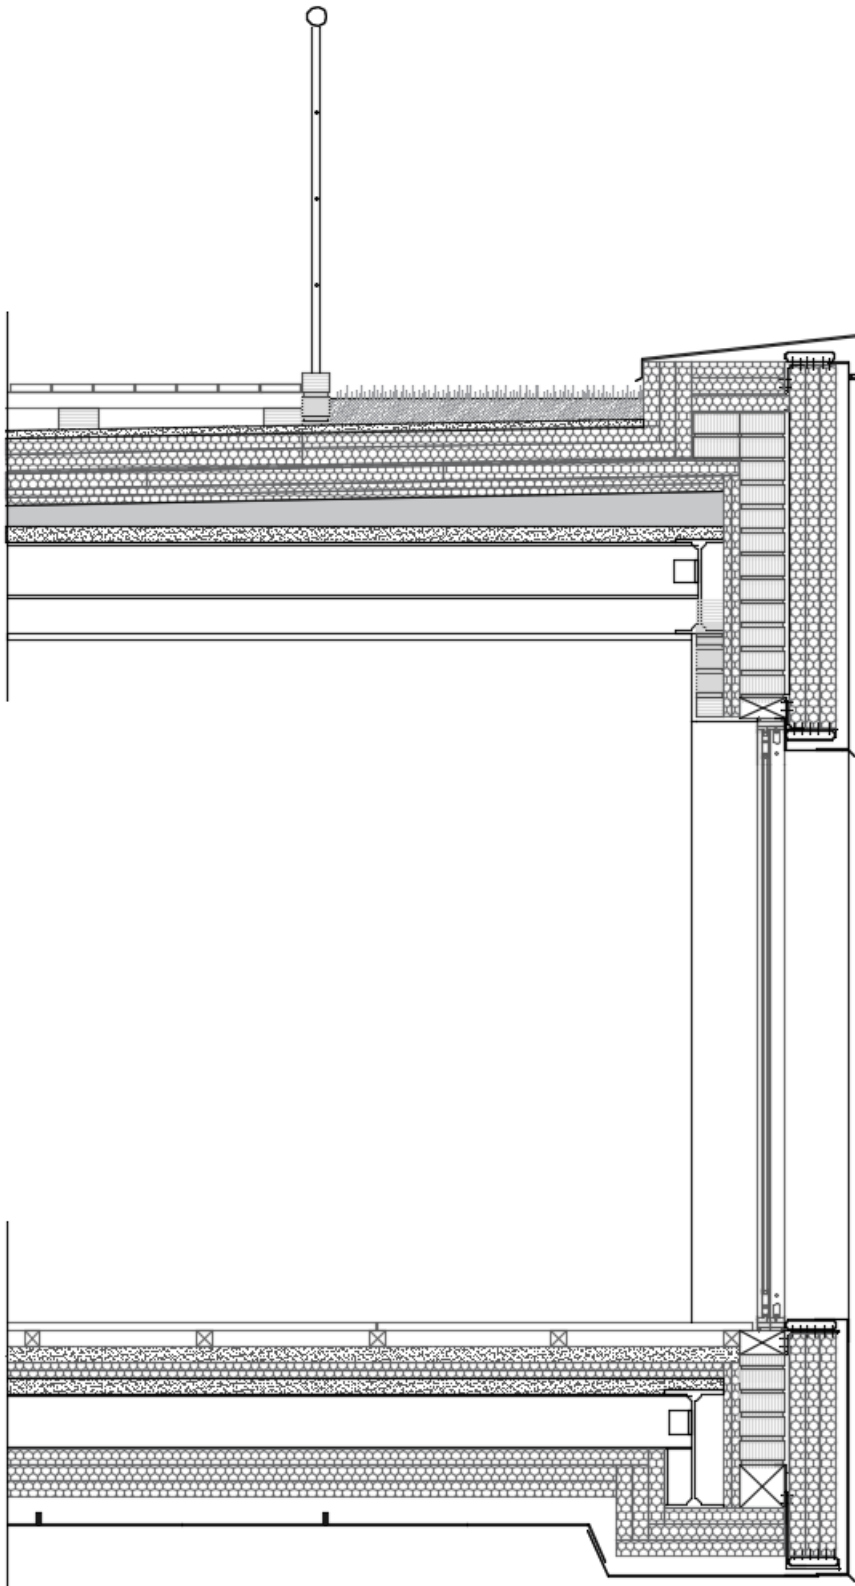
Sección constructiva del estrato superior tras la optimización. Autor: Elaboración propia
